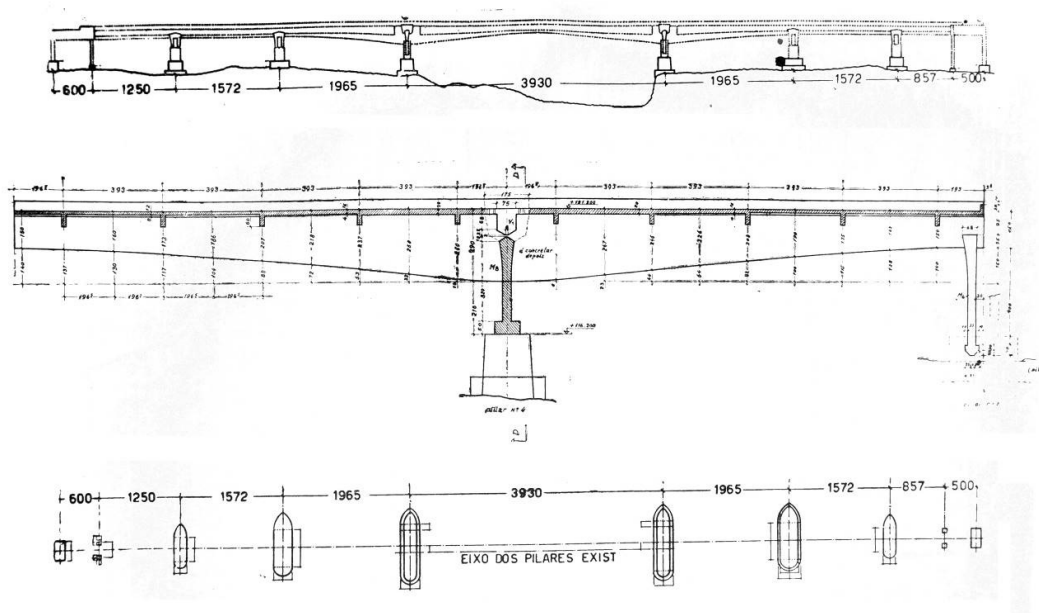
De cima para baixo: Elevação da ponte; detalhe da parte central, o corte abrange metade do vão e o vão adjacente que funciona em balanço para a carga fixa; planta mostrando a situação dos pilares. FONTE: CONCRETO, 1939.
